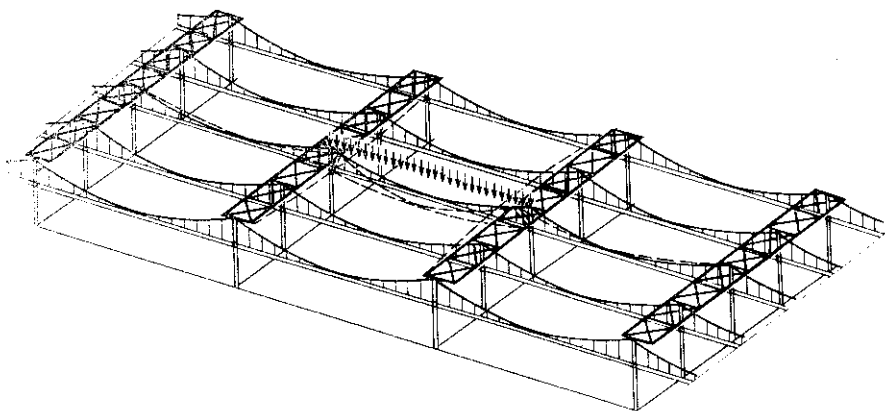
Введение продольных горизонтальных связей по вершинам колонн в схемах с шарнирами на уровне балок
